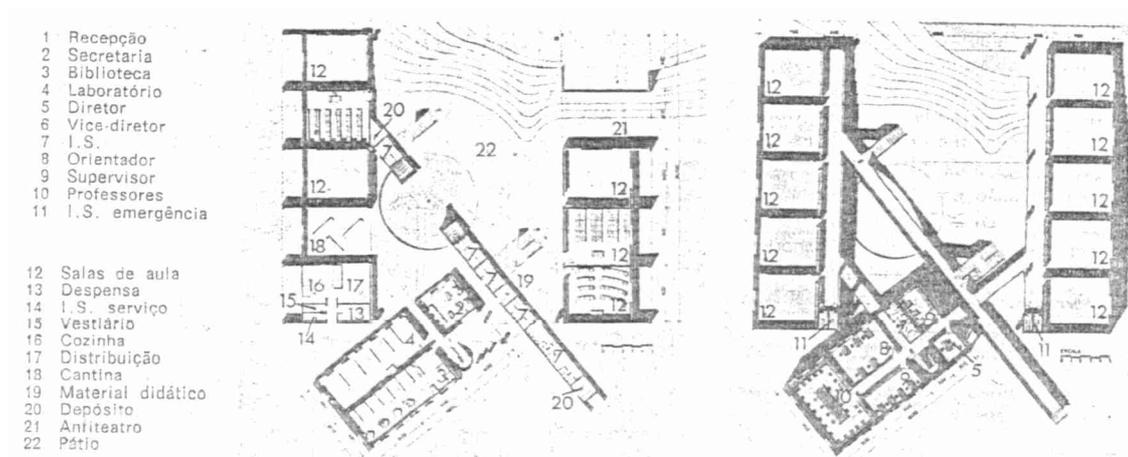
Projeto de sistema construtivo em estrutura de aço com crescimento misto - Menção Honrosa (Éolo Maia, Silvio Podestá e M. Josefina V. Maia).
